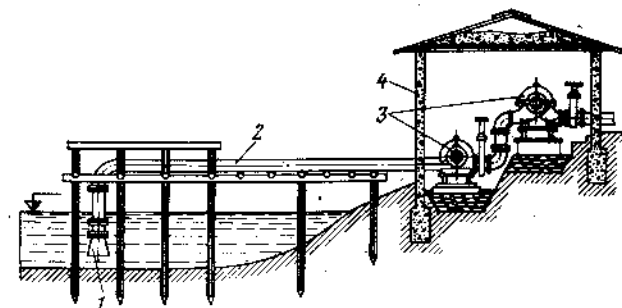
Схема открытого берегового водозабора на свайных опорах:
